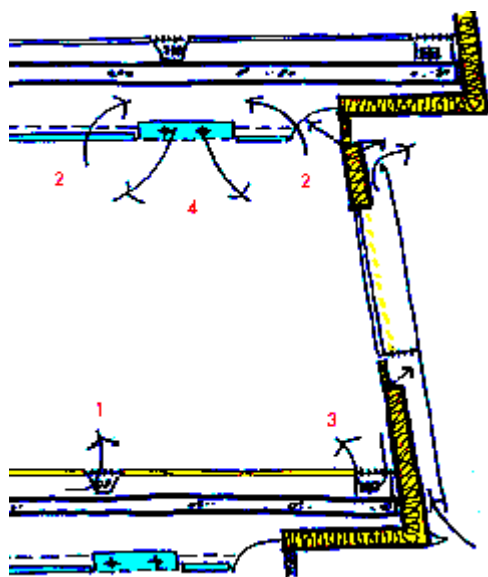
Схема механической вентиляции, отопления и охлаждения помещений:
